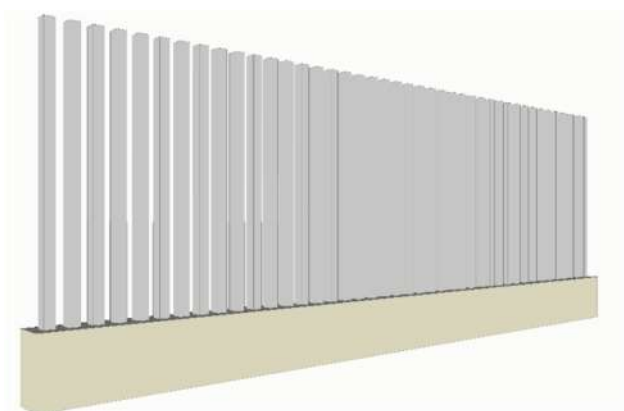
Vista prospettica della recinzione della SSE utente di trasformazione
